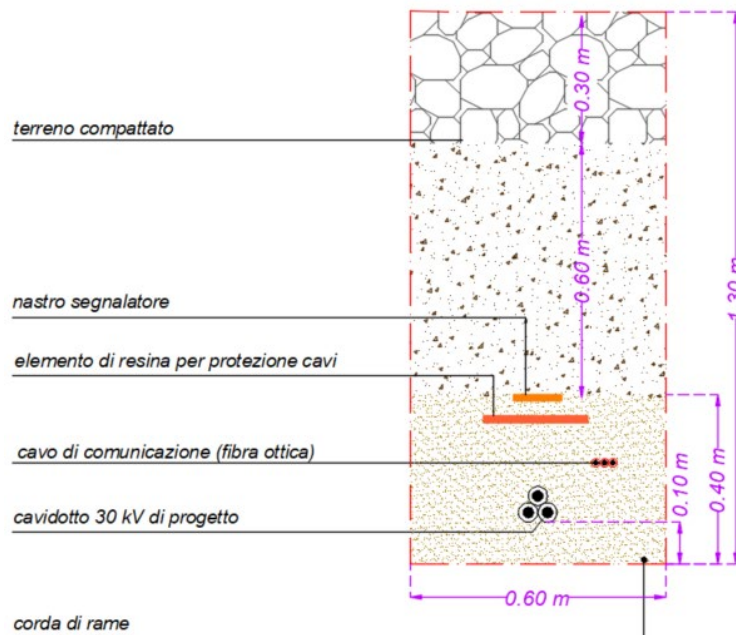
Sezione Cavidotto Singola Terna su Misto stabilizzato
